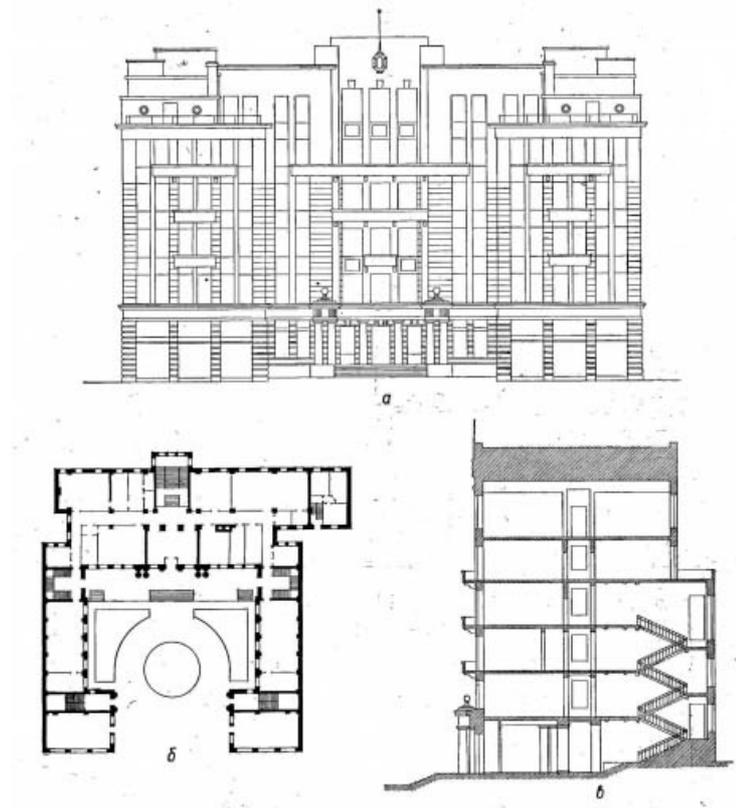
Здание Госстраха. Фасад, план этажа, поперечный разрез
